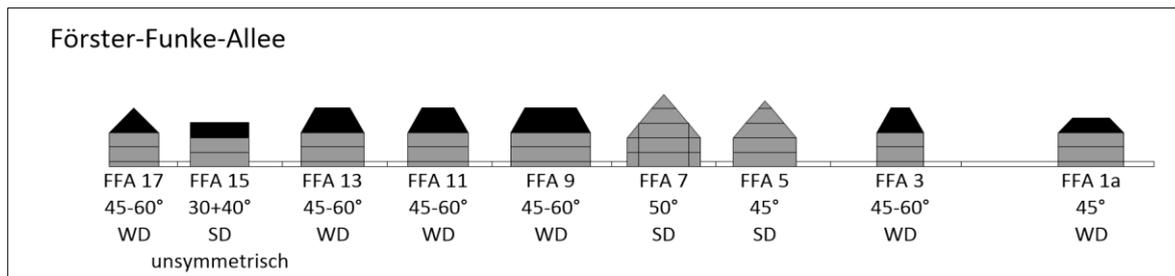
Gebäudeabwicklung Förster-Funke-Allee, schematische Darstellung, ohne Maßstab
